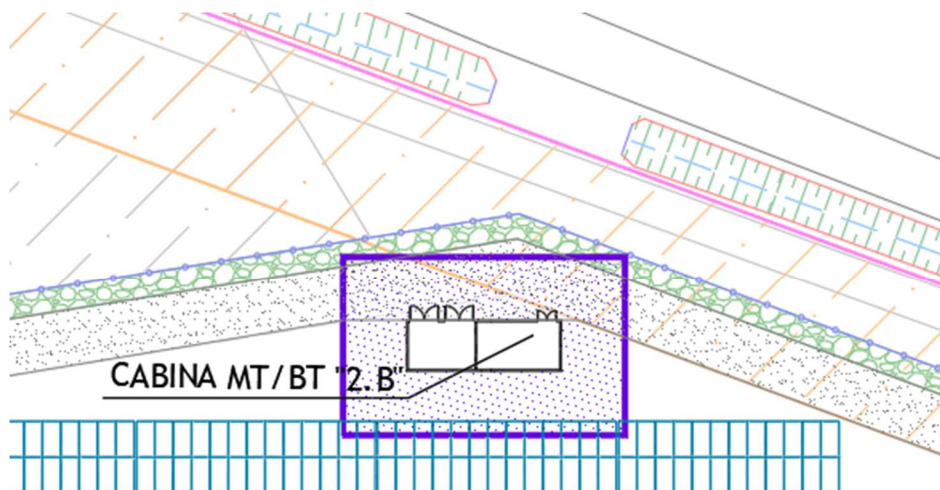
Individuazione fasce di rispetto Cabina MT/BT 2.B
